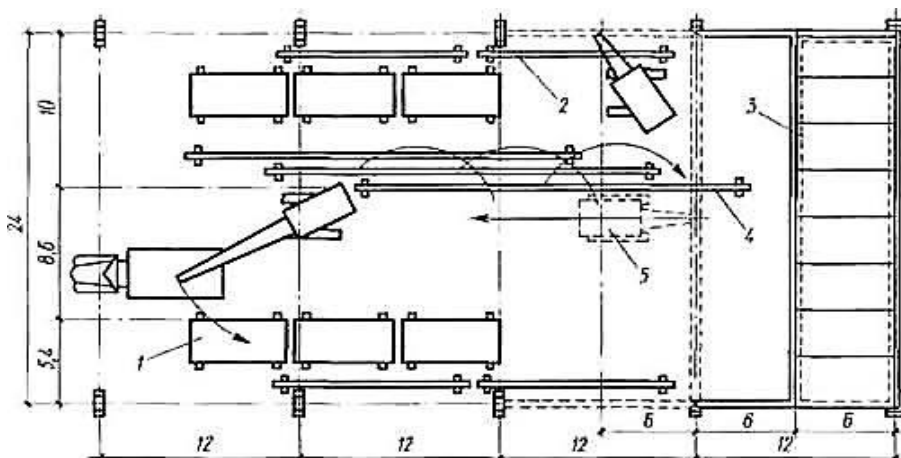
Схема предварительной раскладки конструкций при монтаже покрытия одноэтажного промышленного здания
